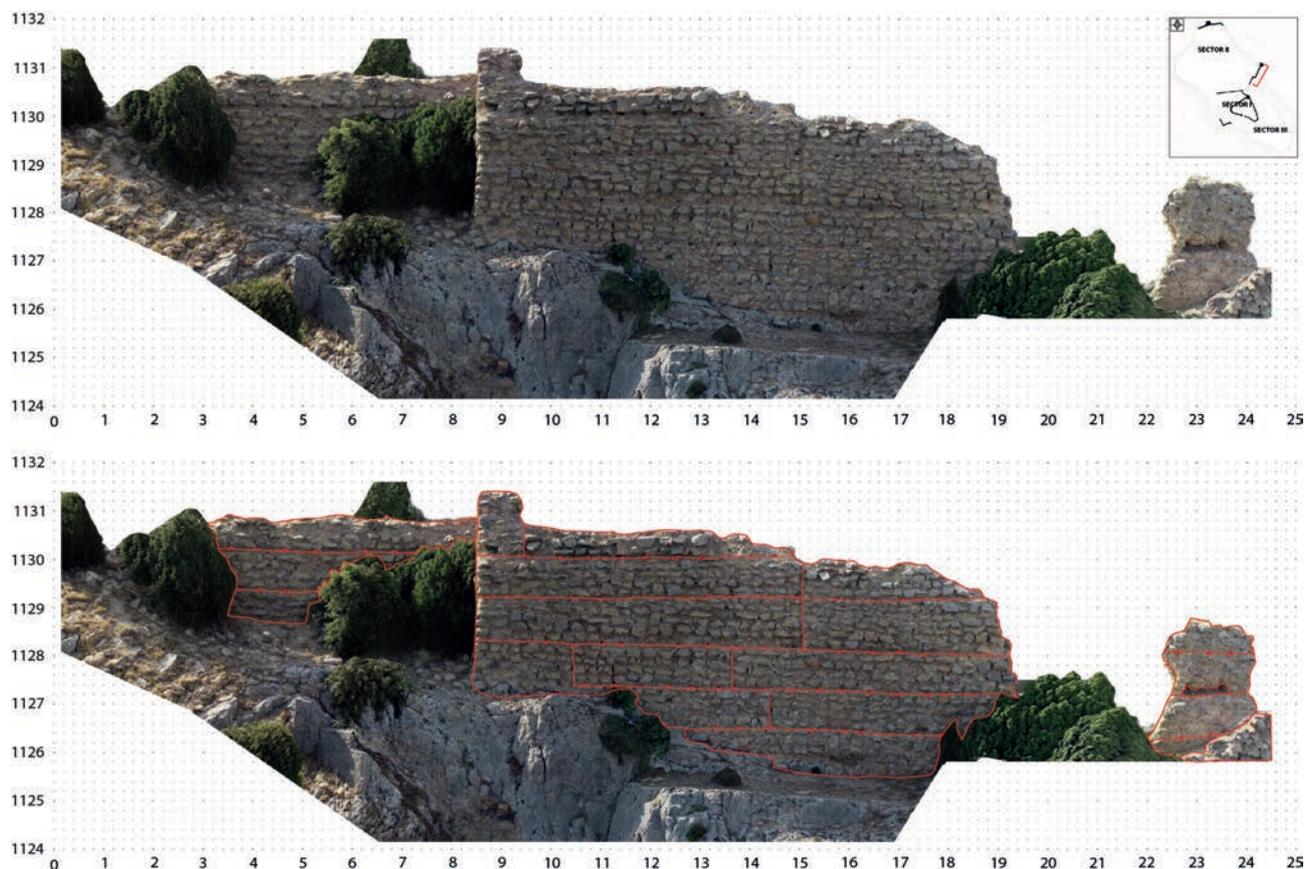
Sector II. Alzado fotogramétrico del segmento de muralla suroriental al que se adosa la Torre II.
